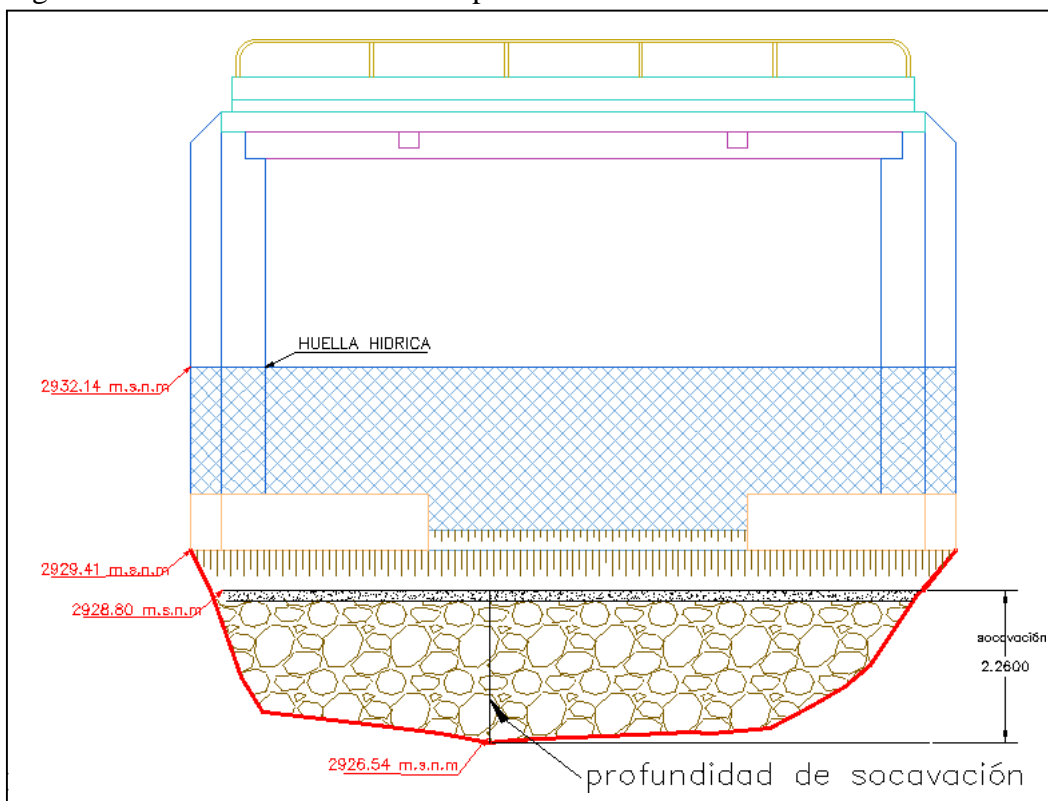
Detalle del corte B-B del puente Plan Manzanas.
